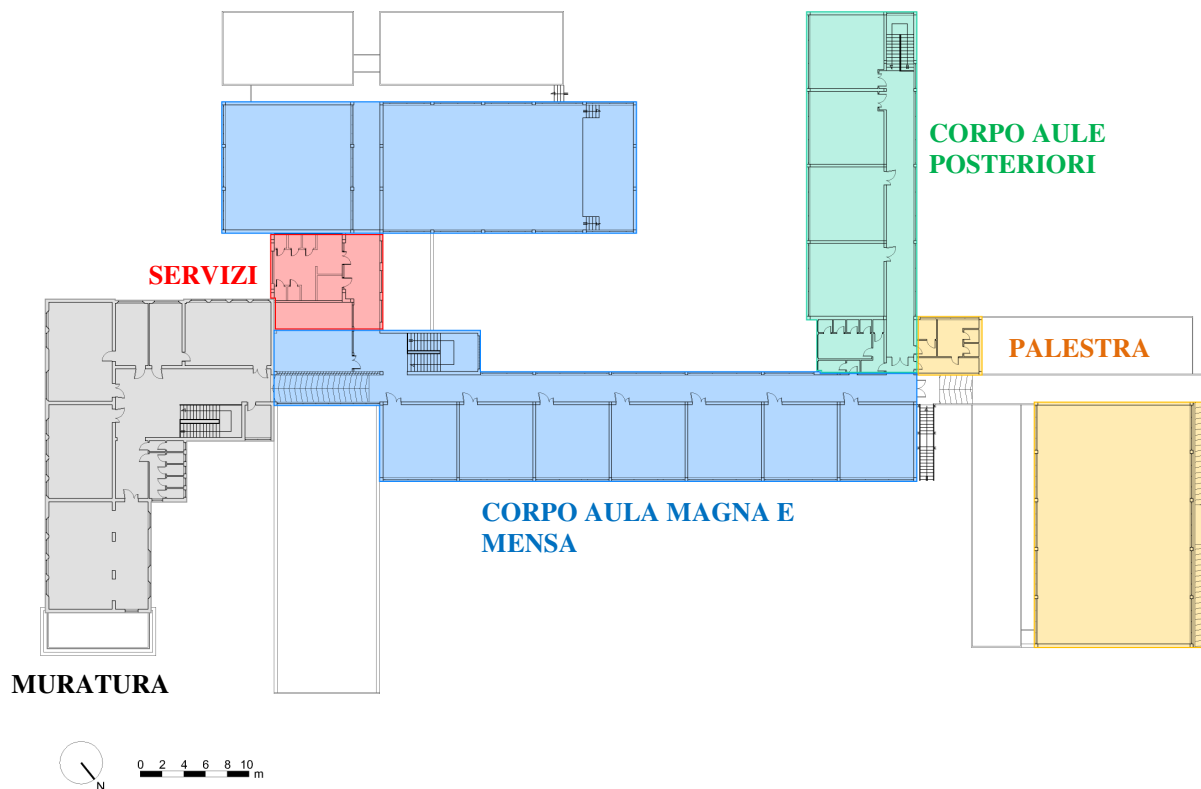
Pianta del piano primo, i colori evidenziano i diversi corpi strutturali
